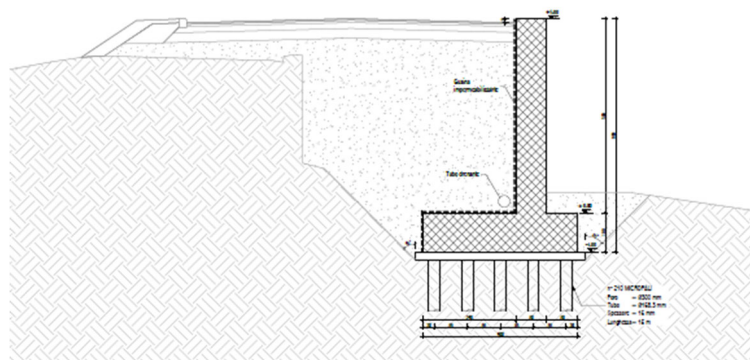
Adeguamento di via Cà Lillina – Sezione trasversale in corrispondenza del muro - Progetto Esecutivo
